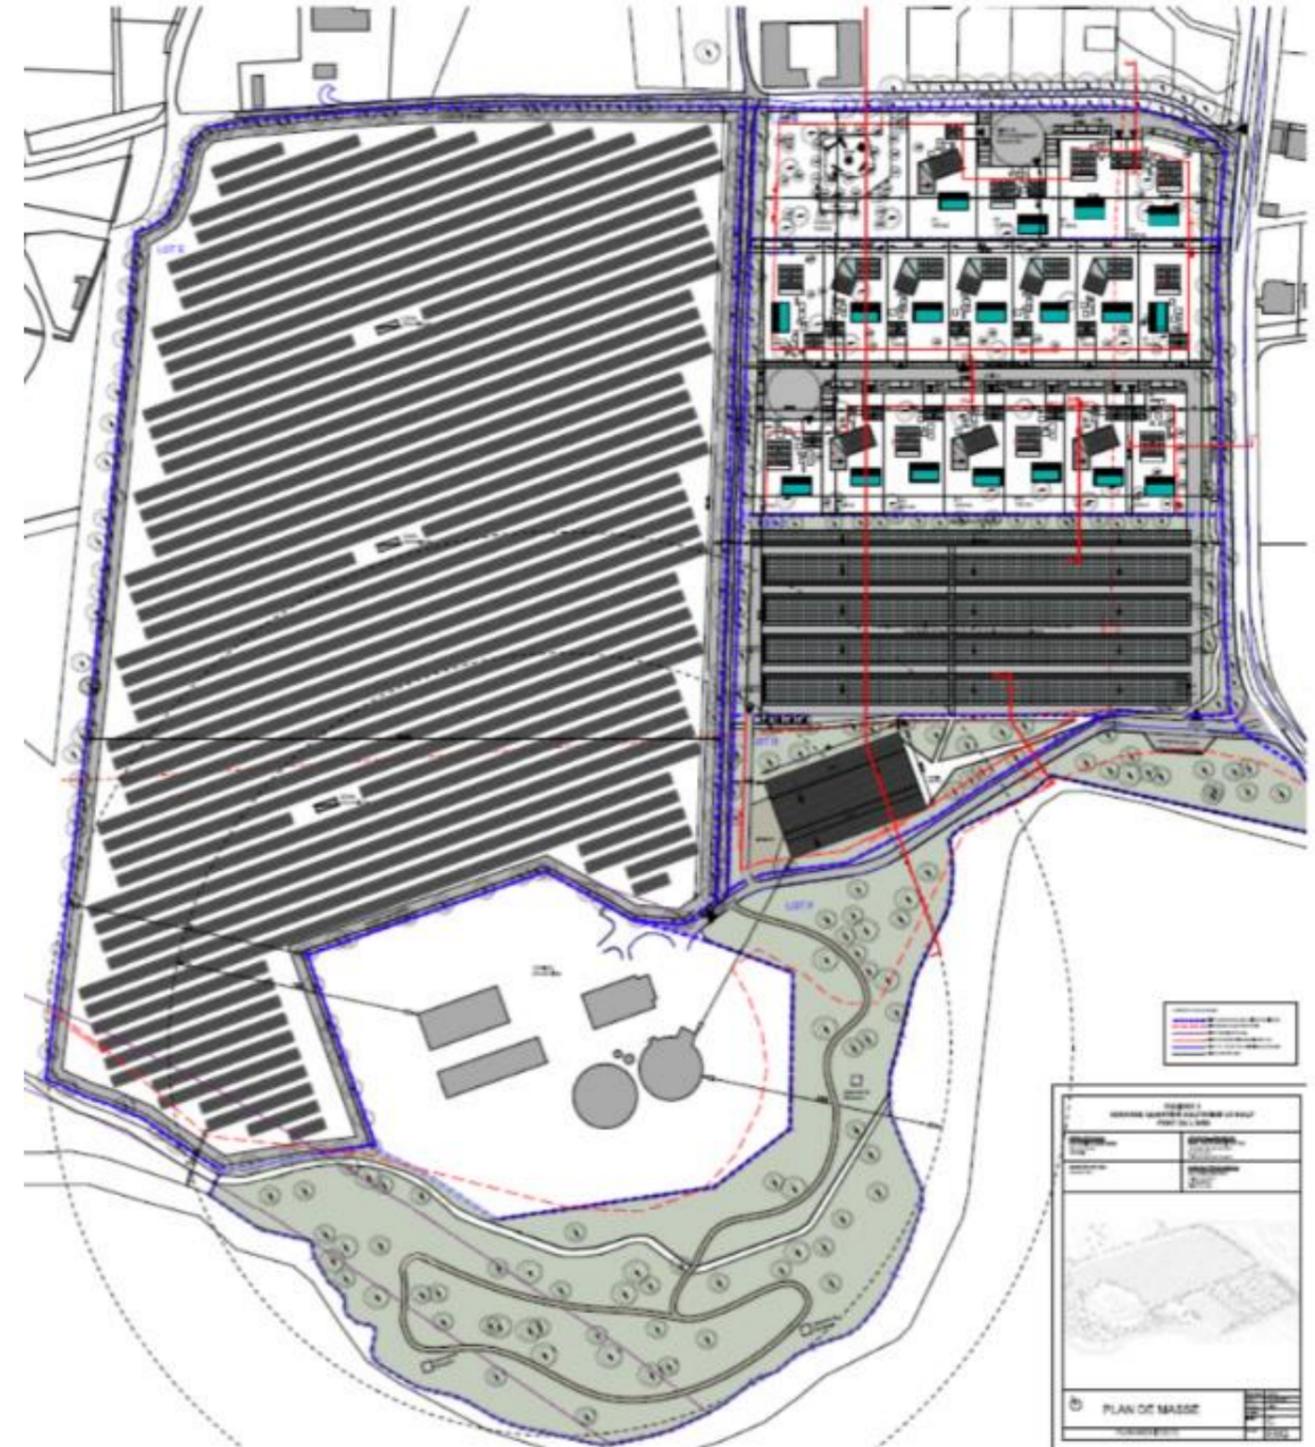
Plan de masse – Version 1 de juin 2017 (source : OECO architectes)
